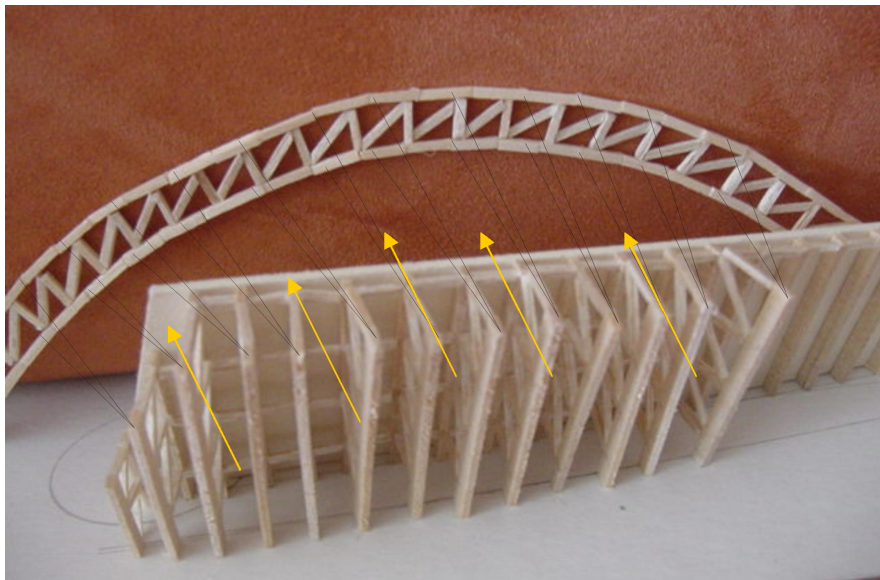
Otra imagen en que las líneas amarillas muestran la dirección en que ejercen su fuerza los tensores, desde la estructura original, es decir la inclinada, hacia el elemento que la refuerza.
